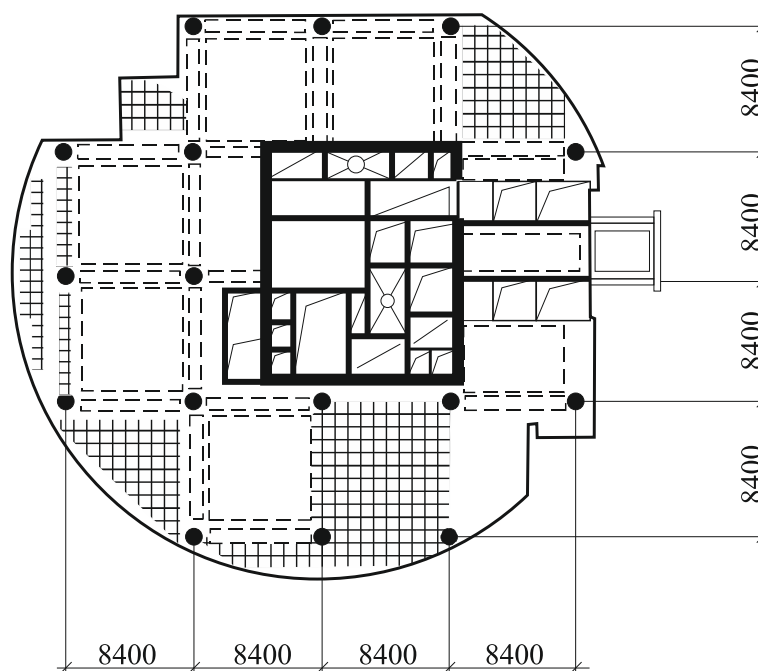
План 38-этажного здания с трубобетонными колоннами [1]
